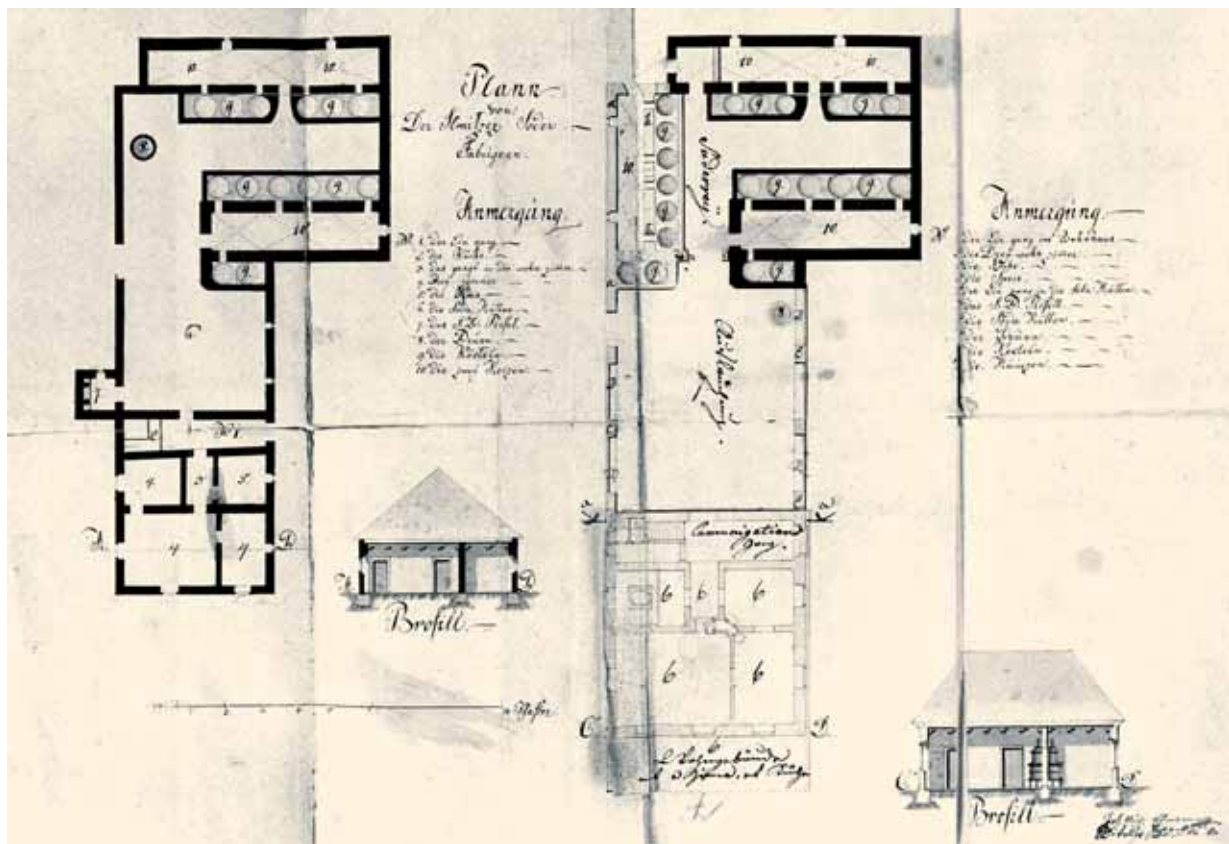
Grundriss und Ansicht („Brosfil“ sic!) der Unterillmitzer Sodafabriken.
